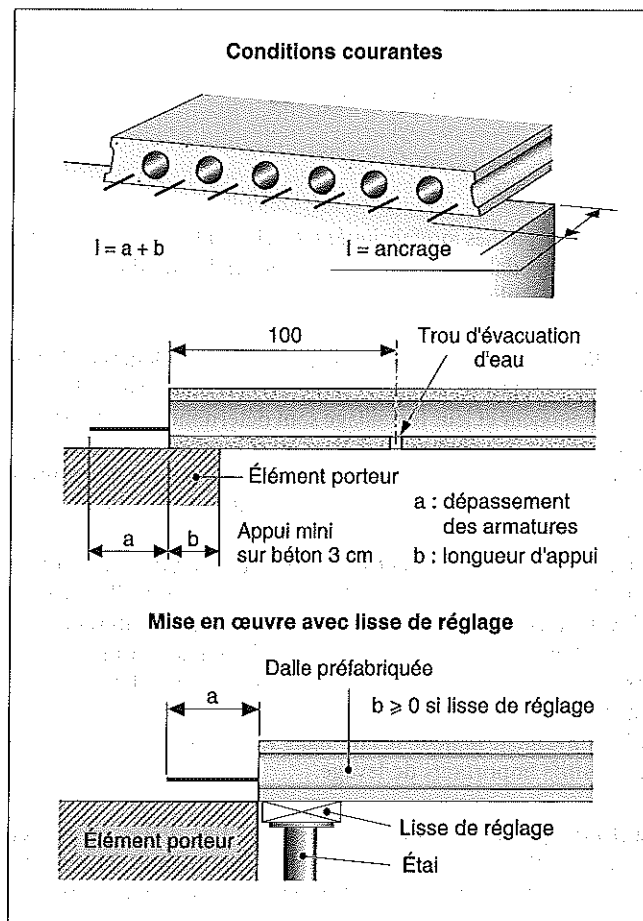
Conditions d'appui et d'ancrage des dalles alvéolées préfabriquées précontraintes.
